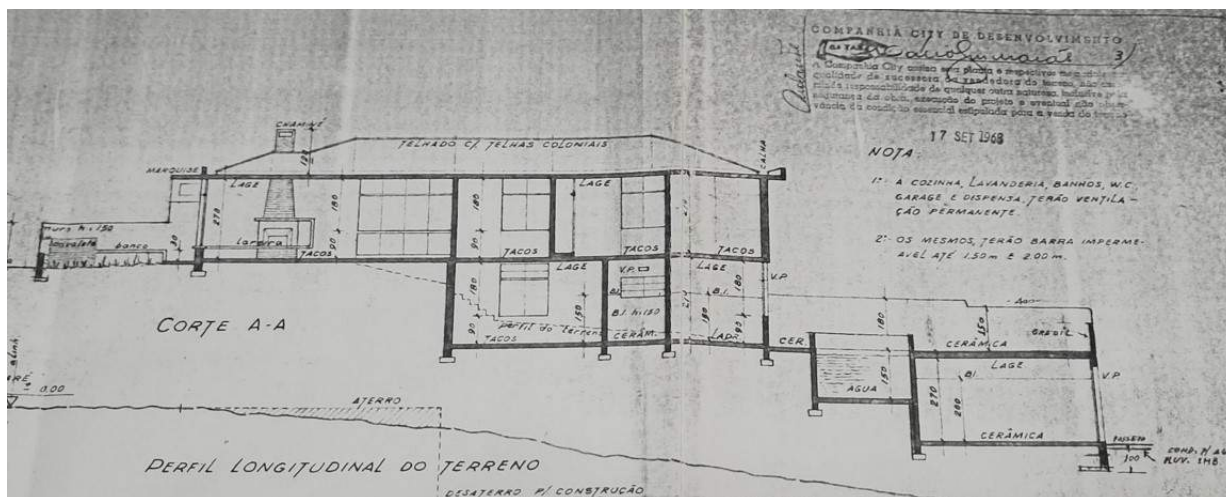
Planta do imóvel avaliando. (Fonte: Arquivo do proprietário)
